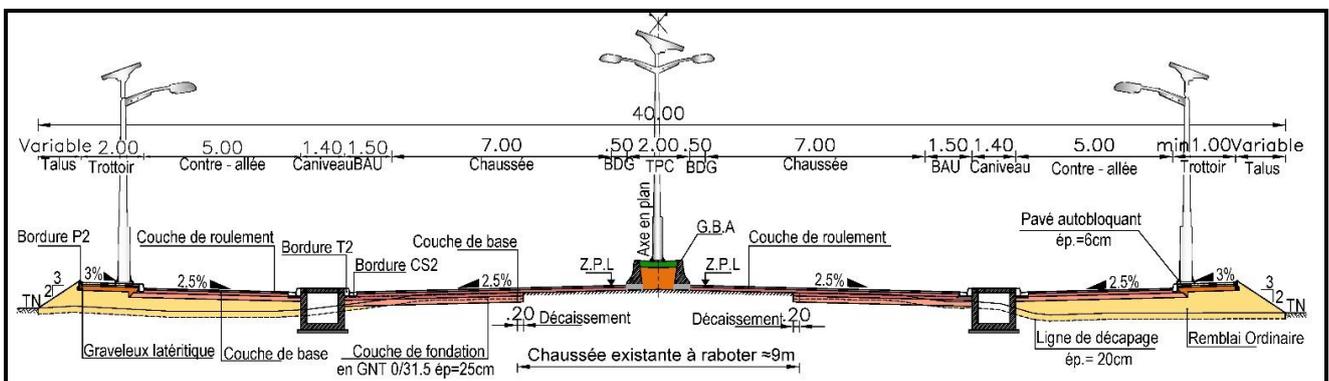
Profil en travers type de la route Ouidah-Hillacondji en zone rurale
